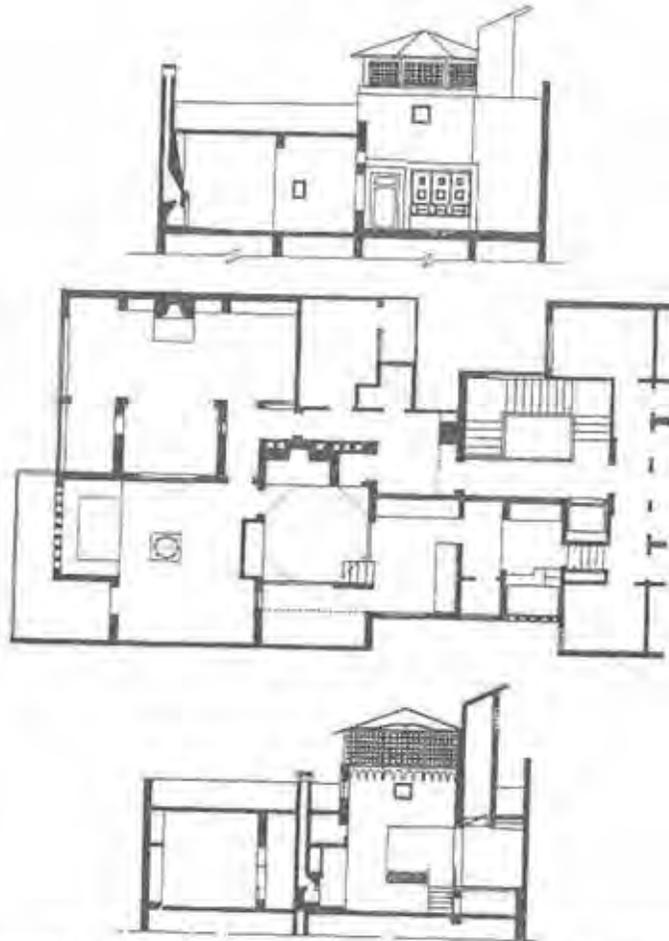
Grundriß und Schnitt durch das Penthouse von Shaira Mehrez in Kairo.
